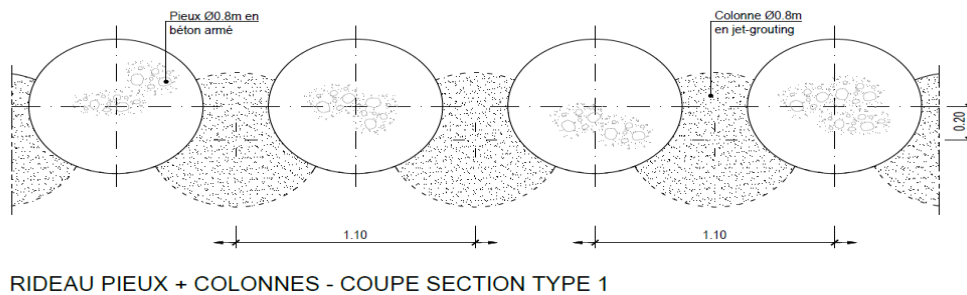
Schéma représentatif du système d'imperméabilisation des pieux construits au-dessous du niveau +7.05
